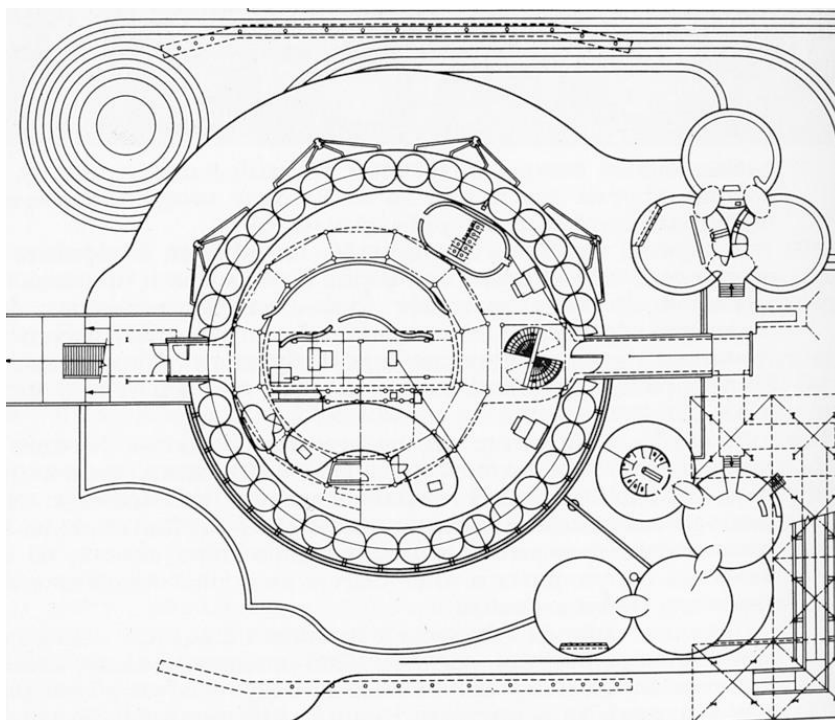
Планировочное решение, совмещенное с генеральным планом павильона Fuji Group
